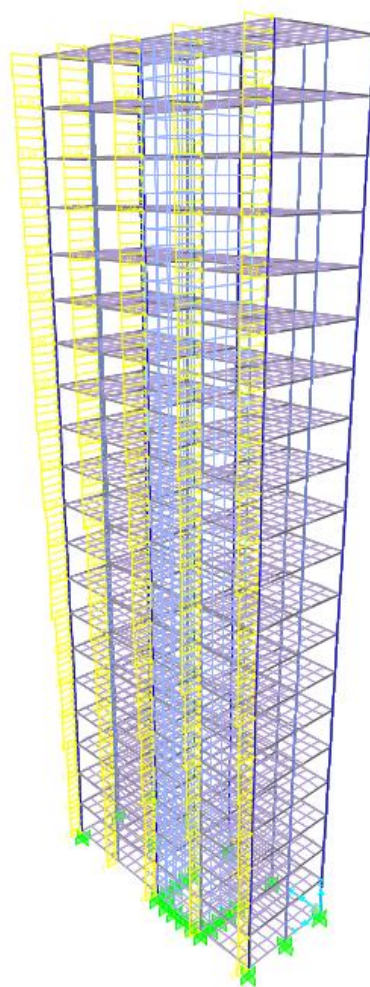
Aplicação do carregamento de vento ao longo dos pilares - Edificação de 20 pavimentos
